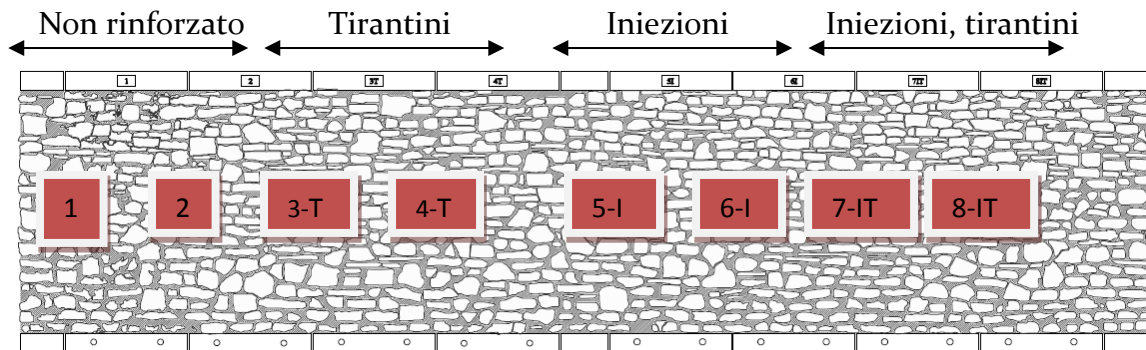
2 - schema geometrico realizzazione muro a tre paramenti
